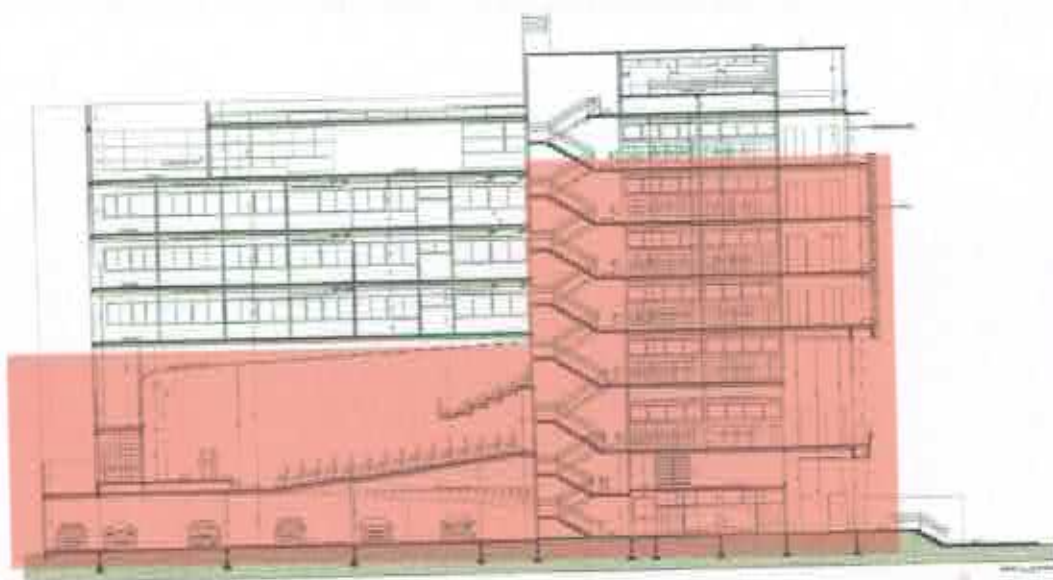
Situação Atual - Corte Longitudinal (executado – em vermelho)
